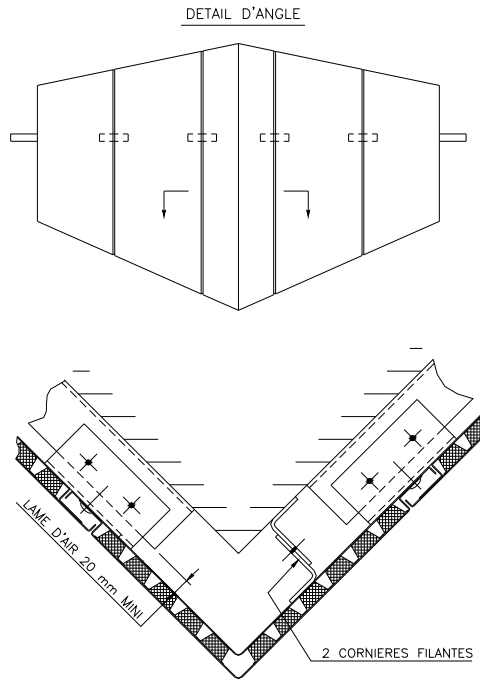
Panneau ISOFRAN à bords pliés Pose verticale - Détail d'angle
